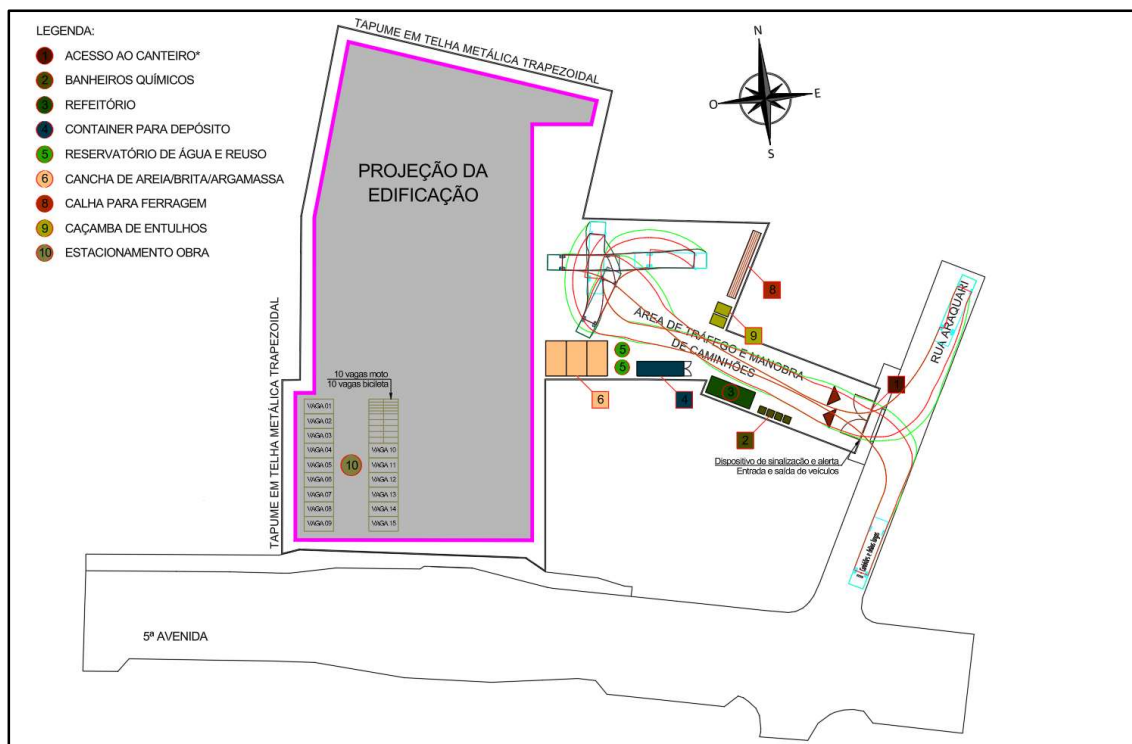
Canteiro de obras projetado – Segunda Fase.
